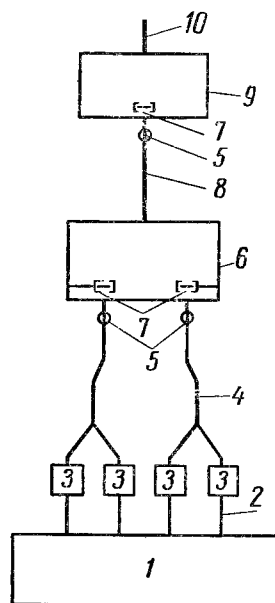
Схема напорного трубопровода крупной оросительной насосной станции:
